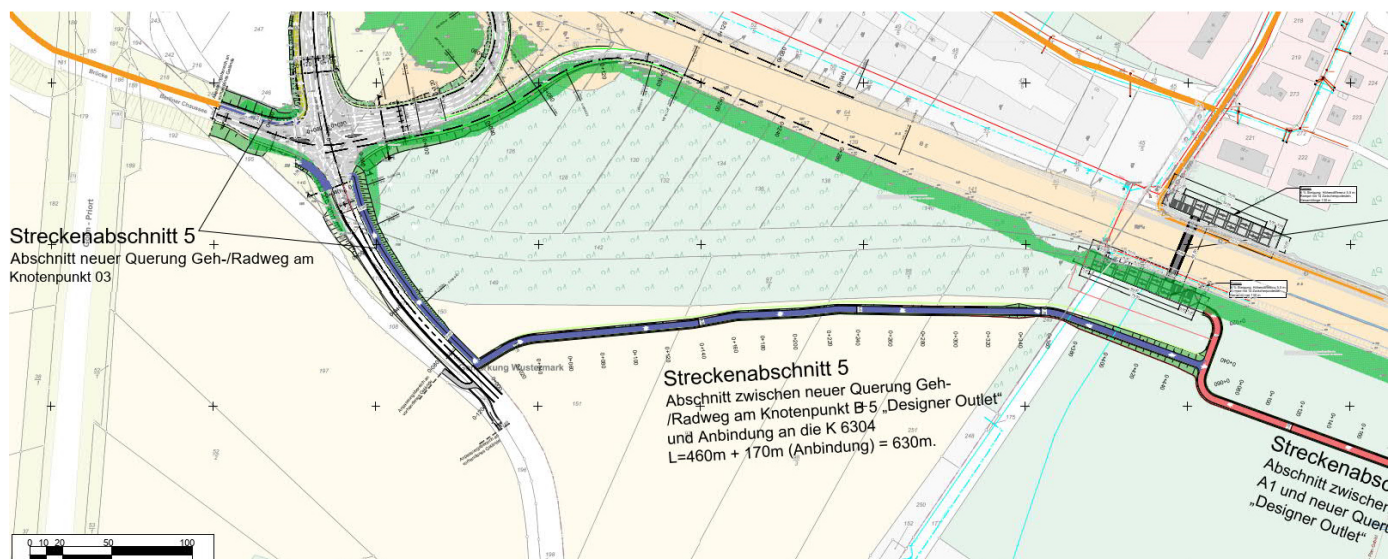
Ausschnitt Übersichtsplan Radverkehrsführungen Untervariante 3 Süd
